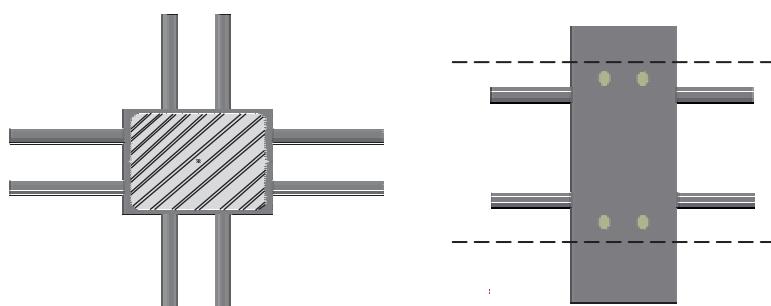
Схема вузла з'єднання монолітного безкапітельного безбалкового перекриття із сталезалізобетонними колонами зі швелерів
